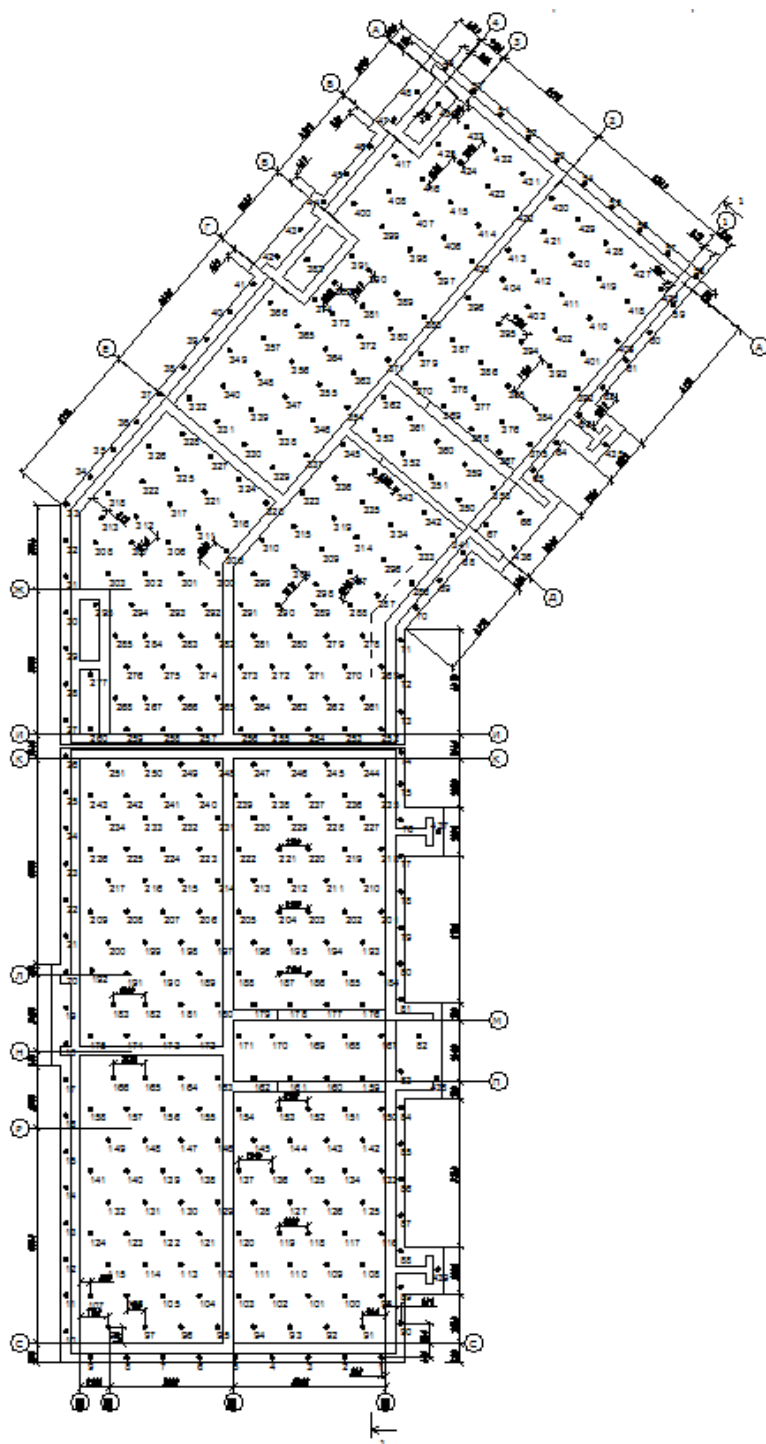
Схема расположения инъекций на плане фундаментной плиты
